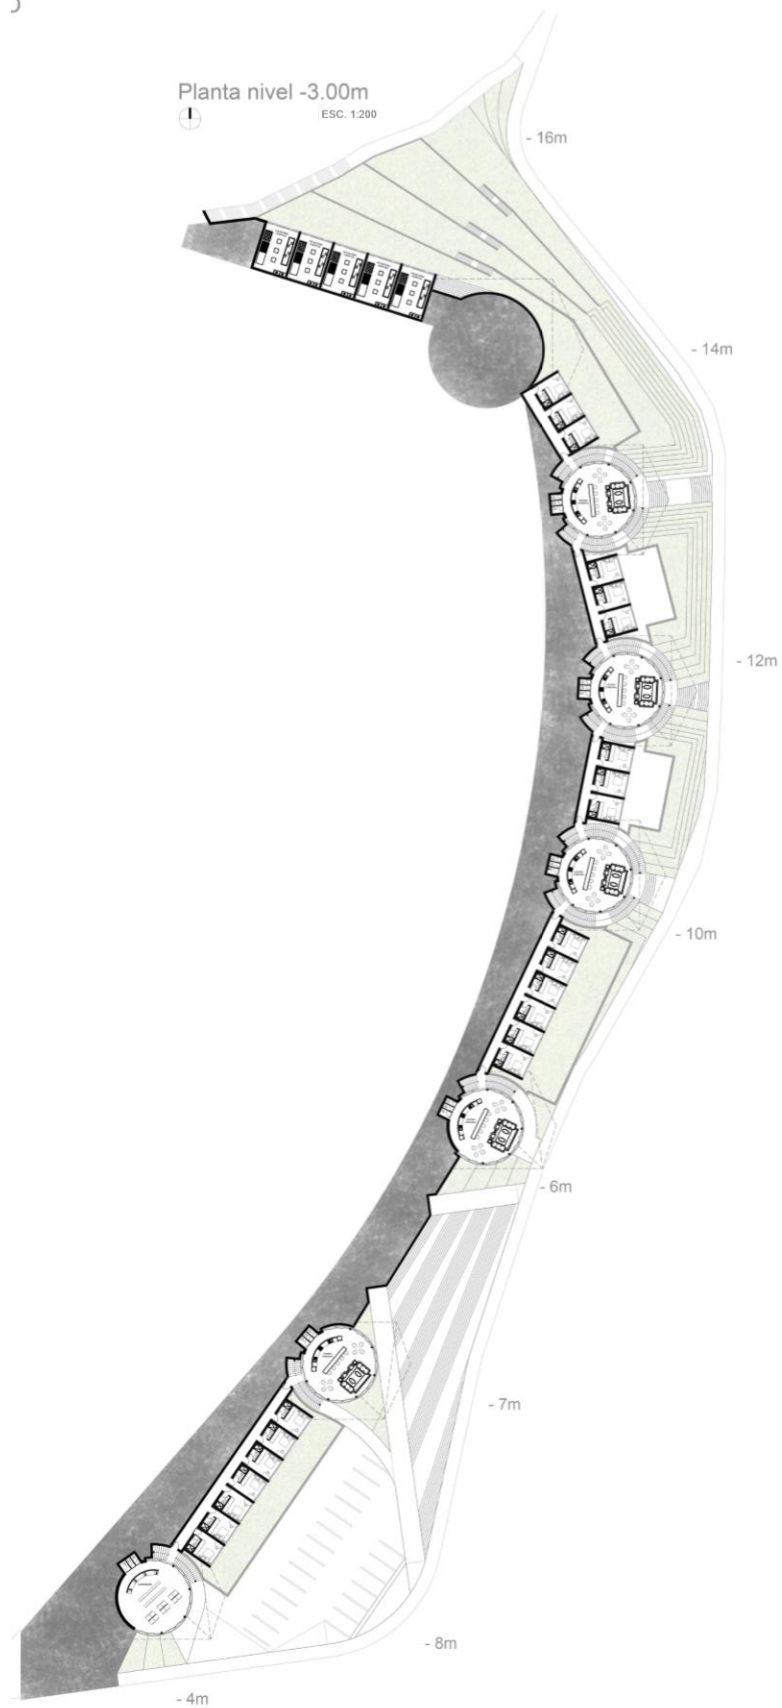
Planta Nivel -3.00 m de la Residencia de Artistas en San Juan.
